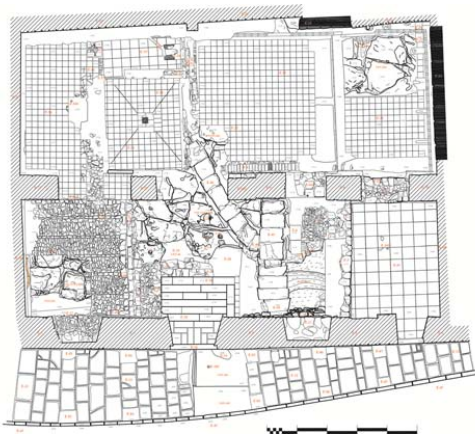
Dibujo de la planta, tras la primera excavación arqueológica. 2009. ARQVIPO.
